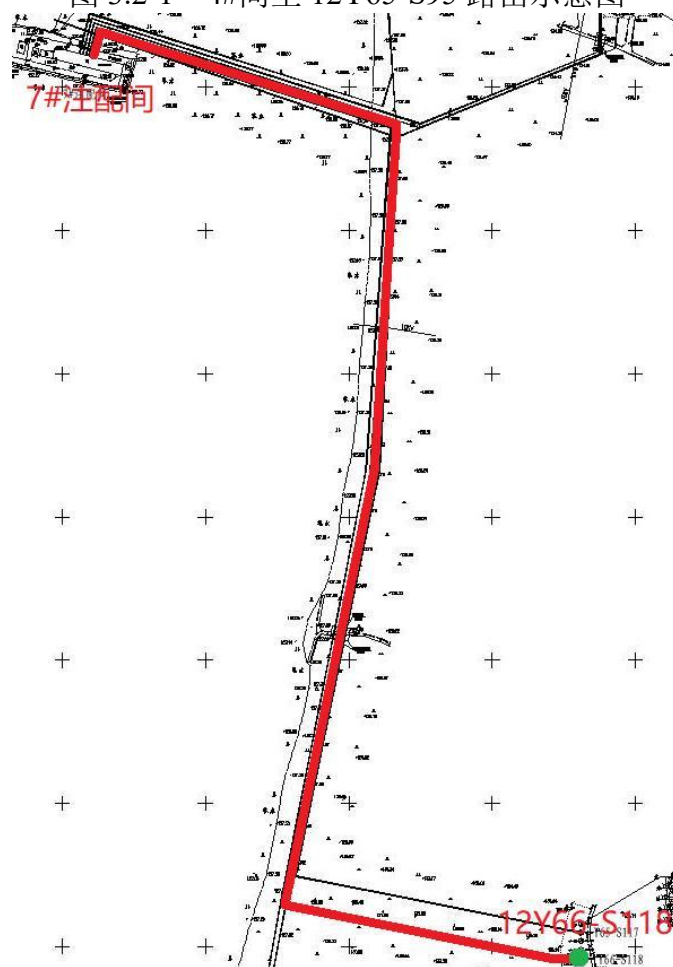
7#间新建 8 井式橇装配水间至 12Y66-S118 平面图
